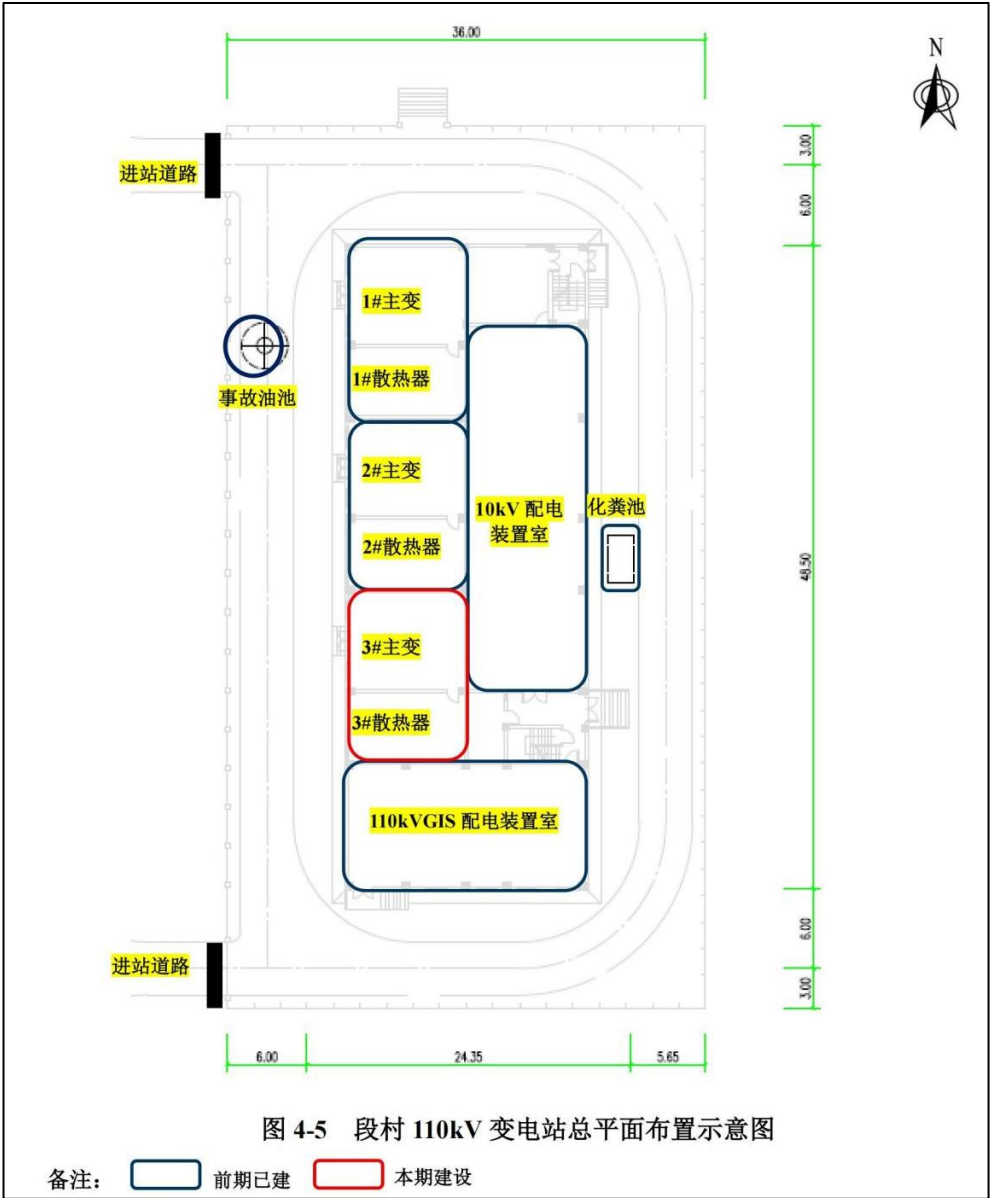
新乡市区段村 110 千伏变电站平面布置示意图
